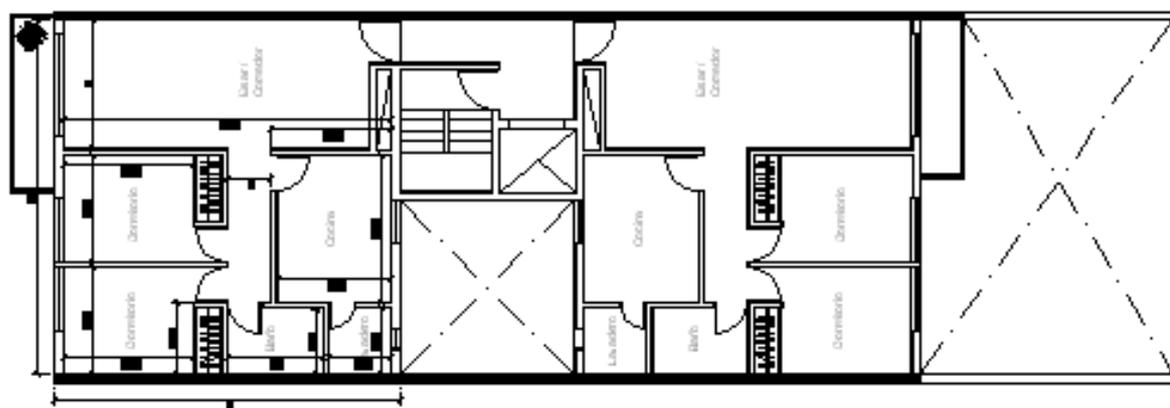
Planta de vivienda tipo “Hogares Departamentos”
